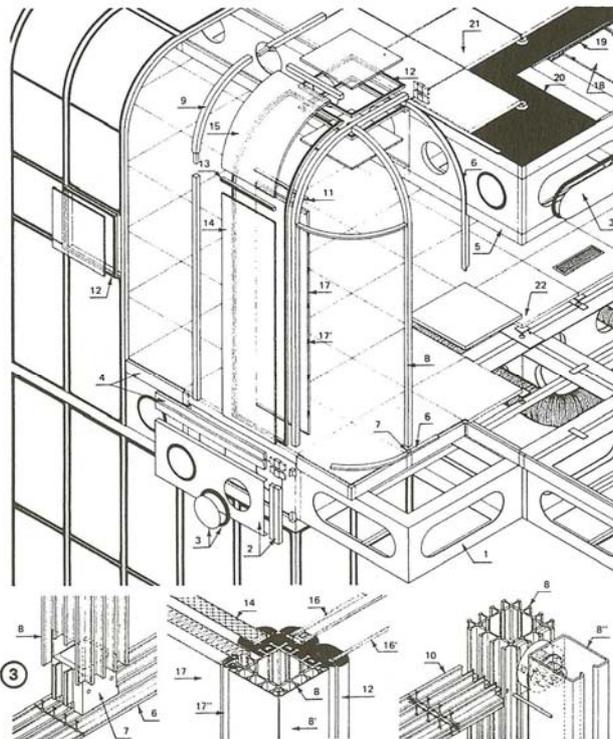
Imagem do projeto de uma edificação desmembrado em elementos e conjuntos de componentes (fonte: DUPLAY, 1985)
